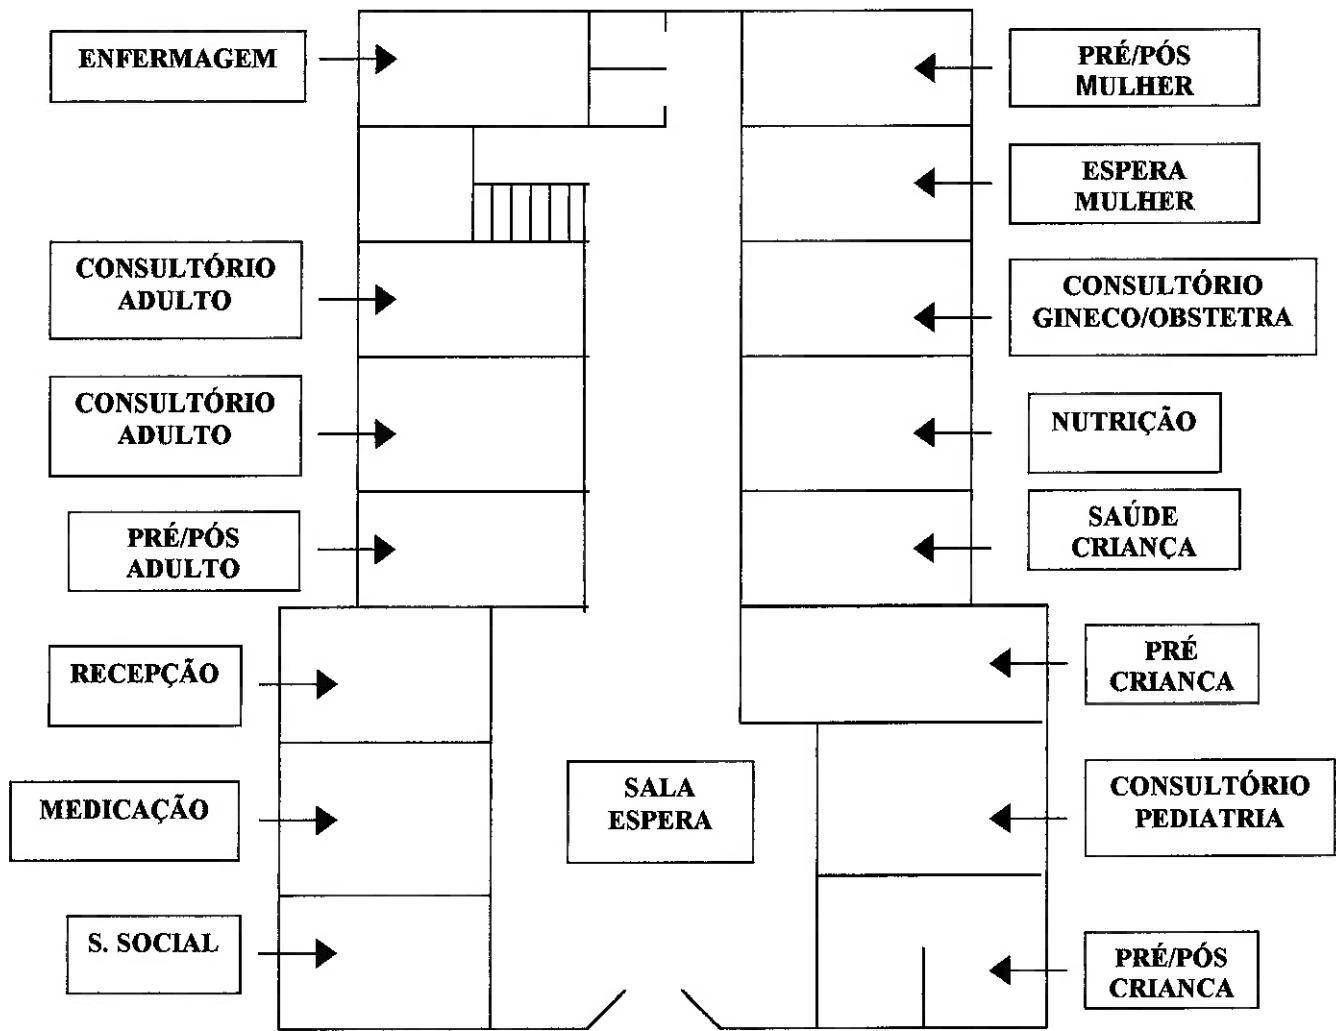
Esquema da Planta do Prédio Principal do Posto de Saúde
